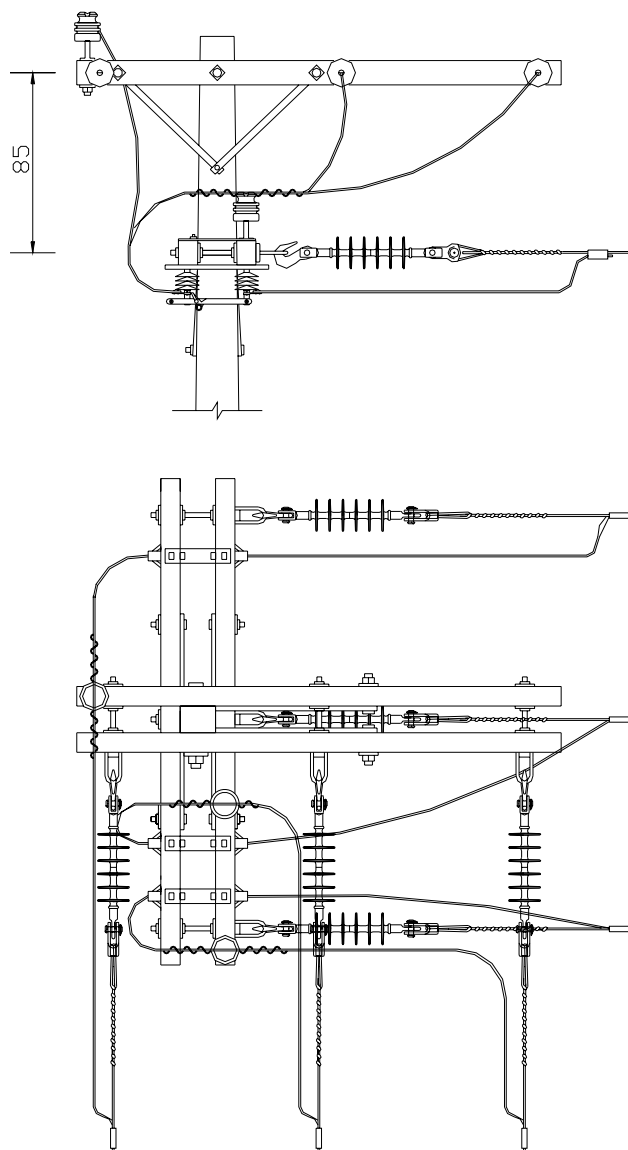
Estrutura M3-N3 (derivação chave faca)
